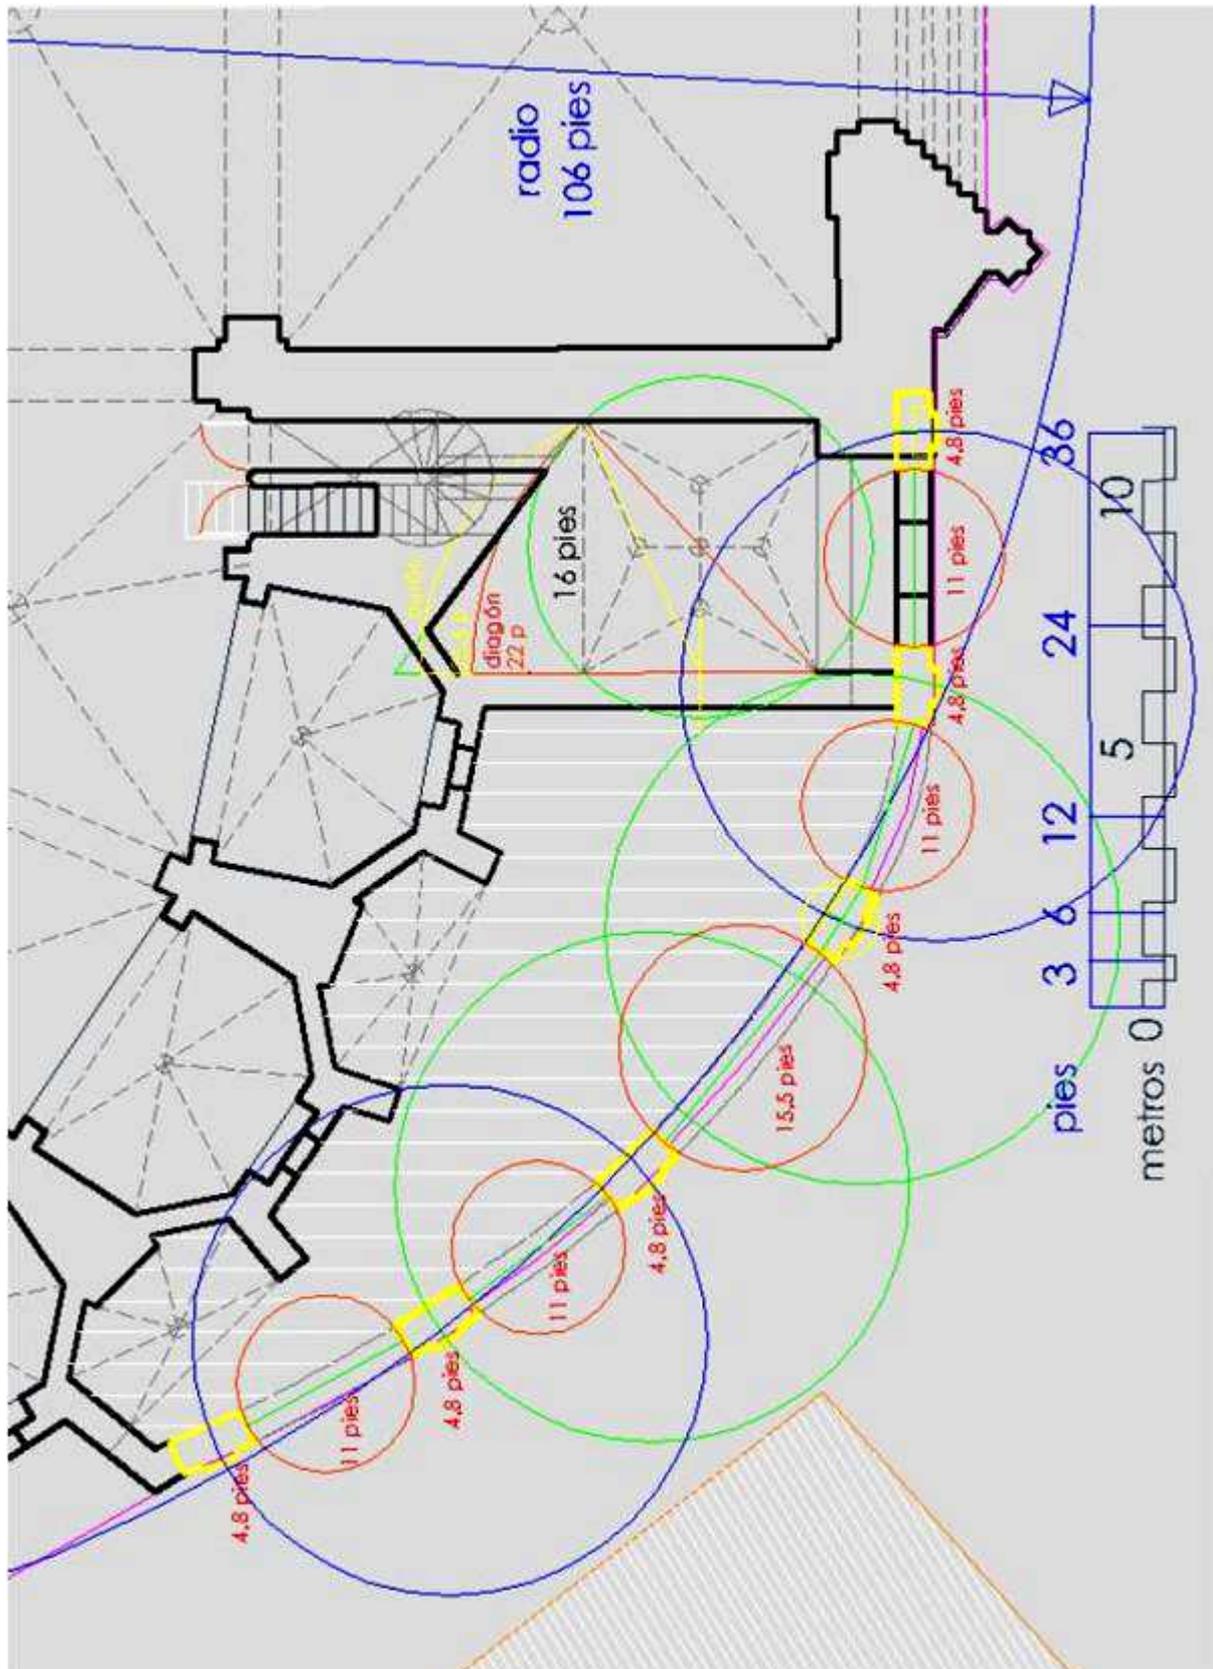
17.6 Planta baja. Estudio de la modulación del trazado en planta.
